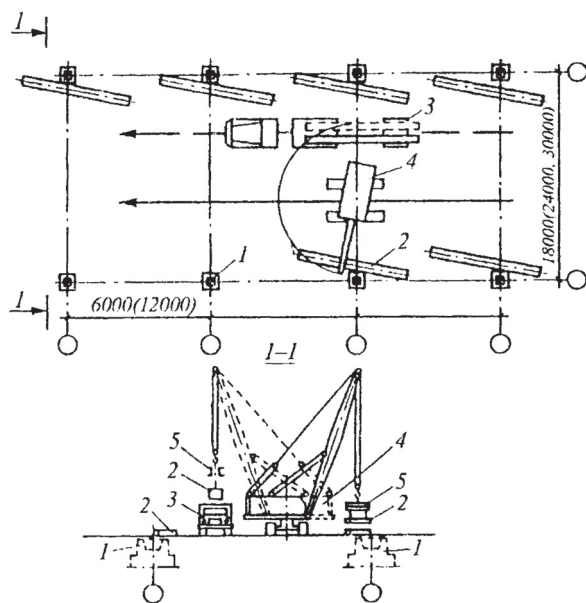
Схема выгрузки и предварительной раскладки колонн в зданиях пролетом 18,24 и 30 м:
